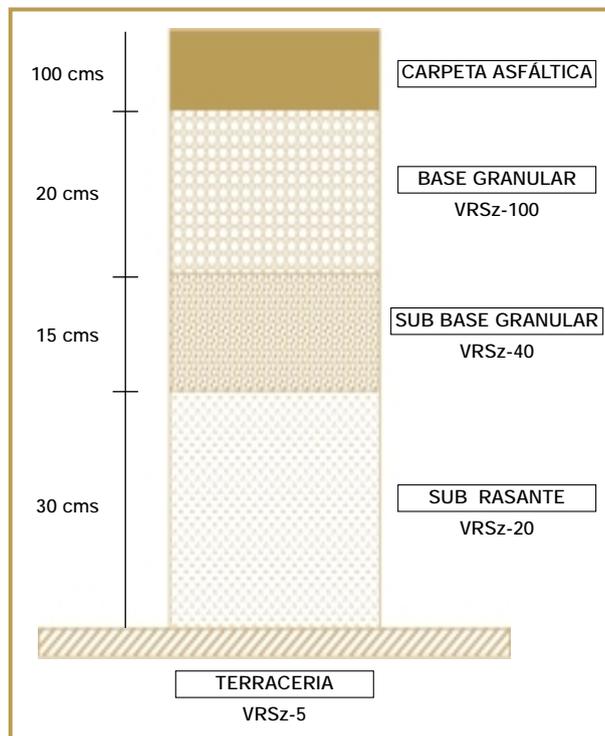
Estructura de pavimento propuesta para el cálculo de ejes equivalentes.
